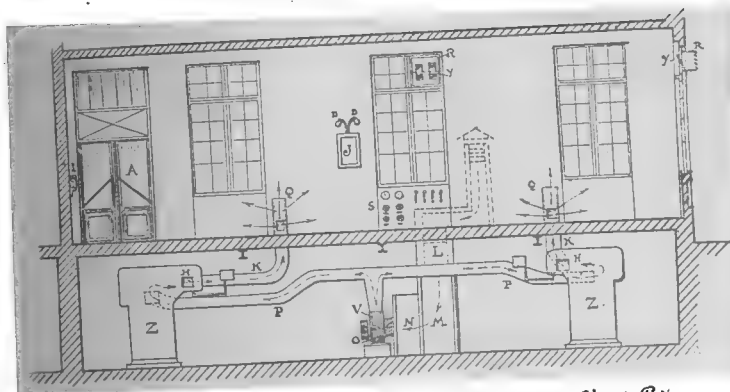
Coupe longitudinale montrant schématiquement l'installation.
